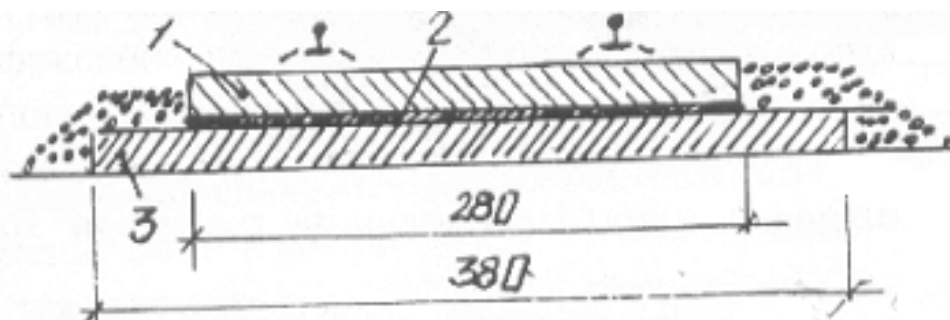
Подрельсовое основание со сборными железобетонными плитами (ФРГ): 1 – готовая плита; 2 – битуминизированный слой; 3 – слой гравия с вяжущими добавками
